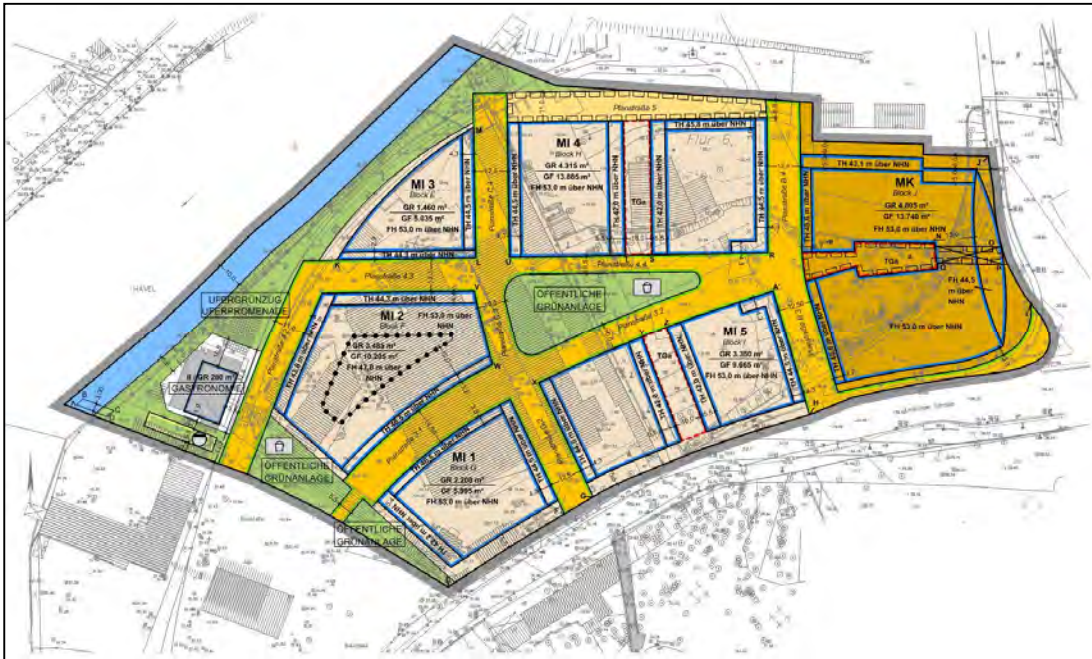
Bebauungsplan Nr. 36-1, „Speicherstadt / Leipziger Straße“ [B-PLAN_36-1, 2014]
